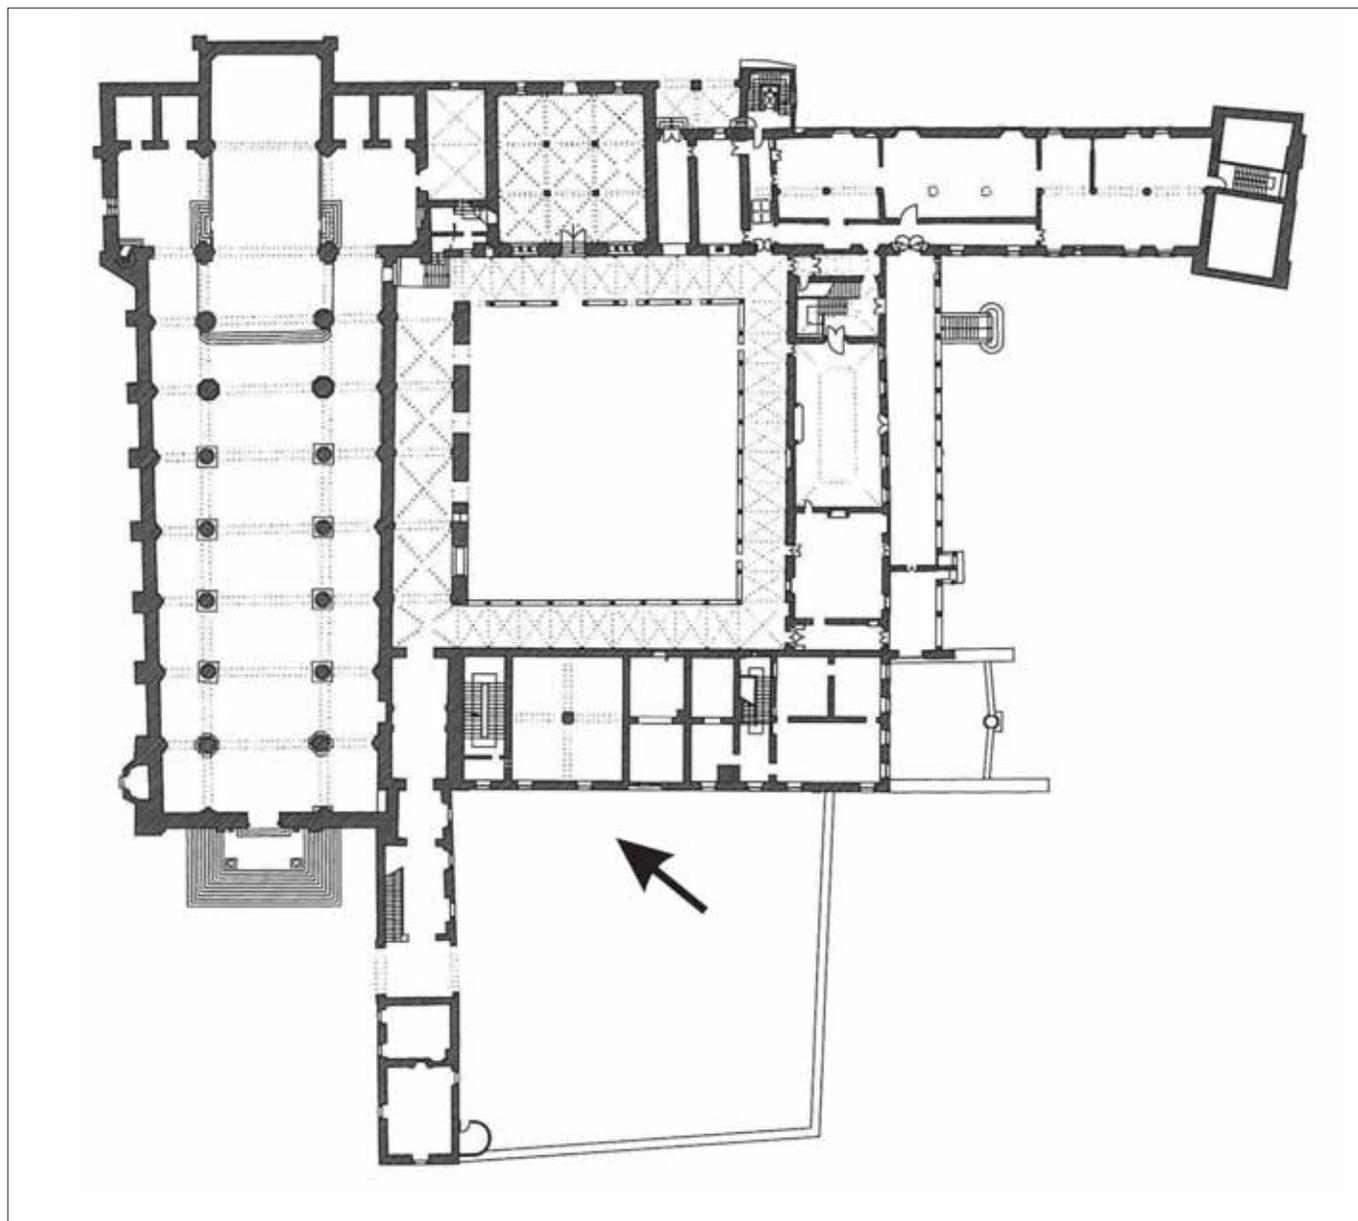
Planimetria del complesso (rilievo arch. A. Rondena e arch. G. Carminati), con aggiunta dell'indicazione dell'area di scavo.
